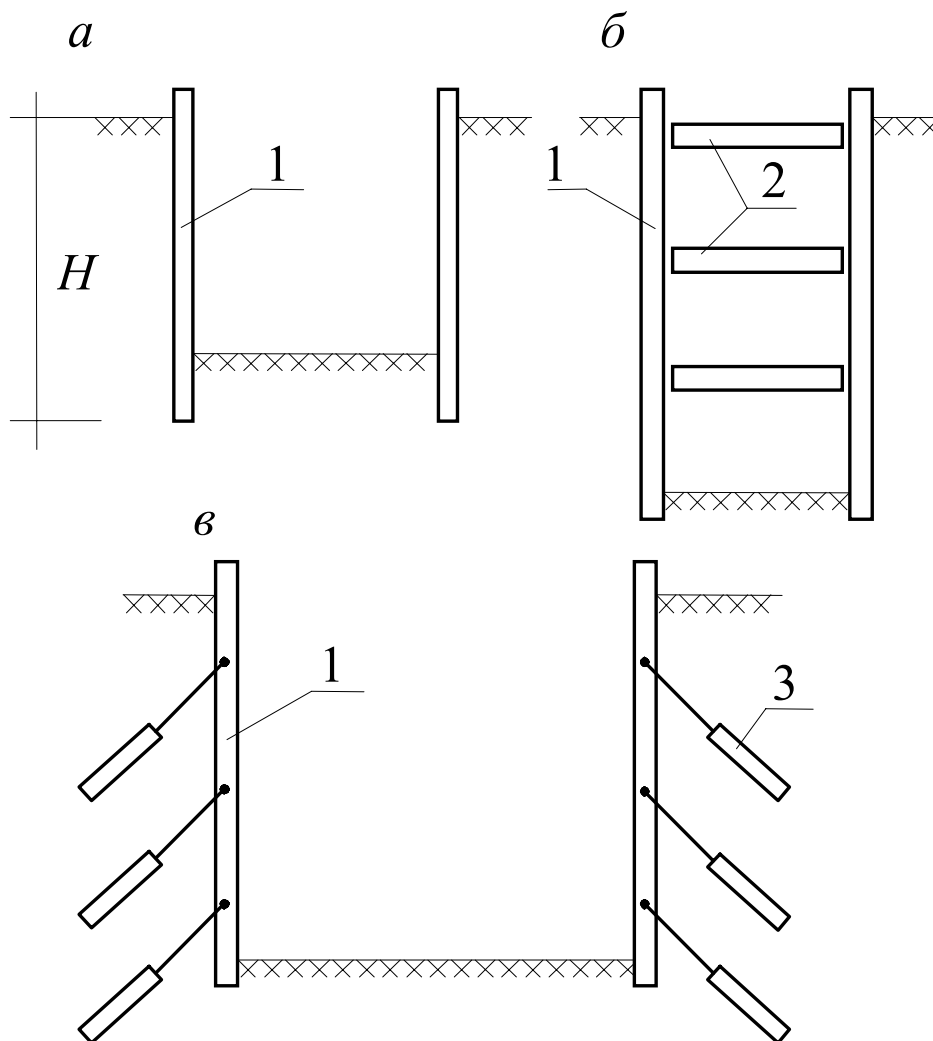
Конструктивные схемы сооружений с параллельными стенами: *а* – консольная стена (H – глубина заложения стены); *б* – стена с креплением параллельными распорками; *в* – стена с креплением анкерами; 1 – стена; 2 – распорки; 3 – анкеры
